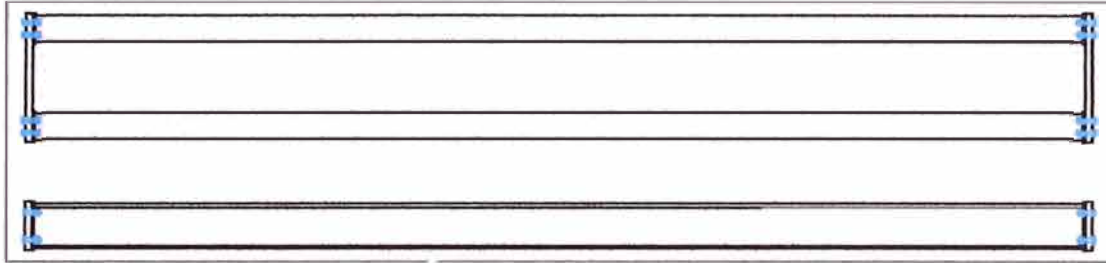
Planta y Elevación del Carril Doble L=5.9m.
